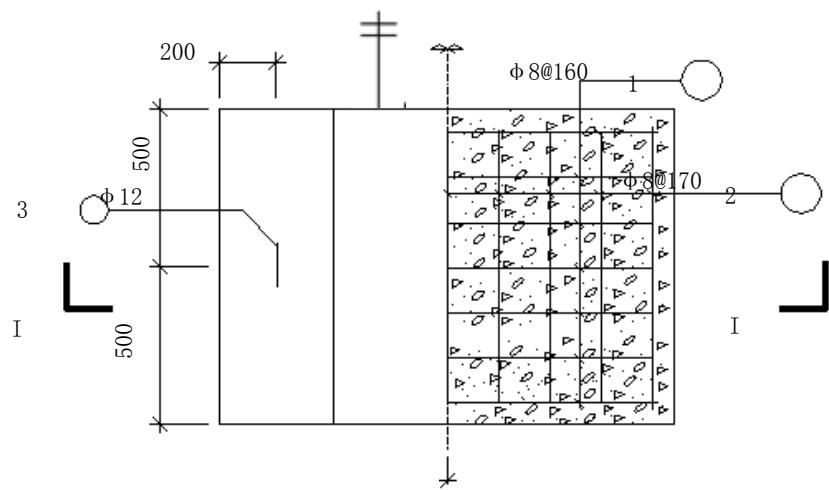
钢套管保护纵断面示意图 A-A 剖面图
